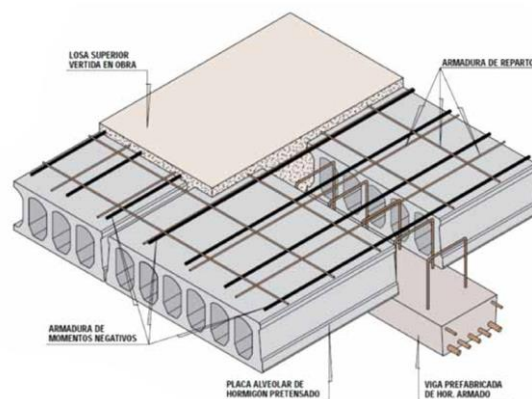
Modelo de losa alveolar pretensada. [Fuente: Alve Prefabricados](#)
